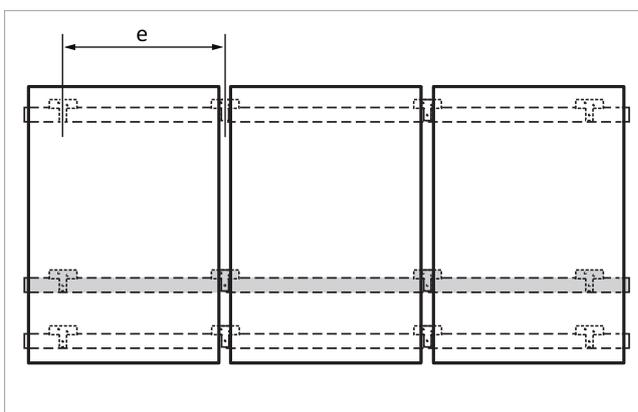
Traversa supplementare di bloccaggio (montaggio affiancato)
